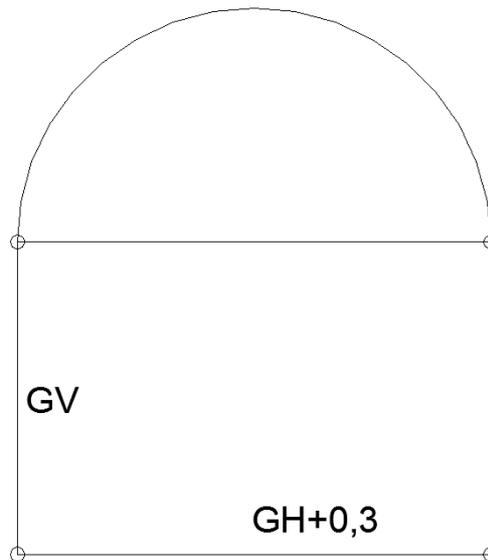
Configuration de tunnel avec une section en fer à cheval.
